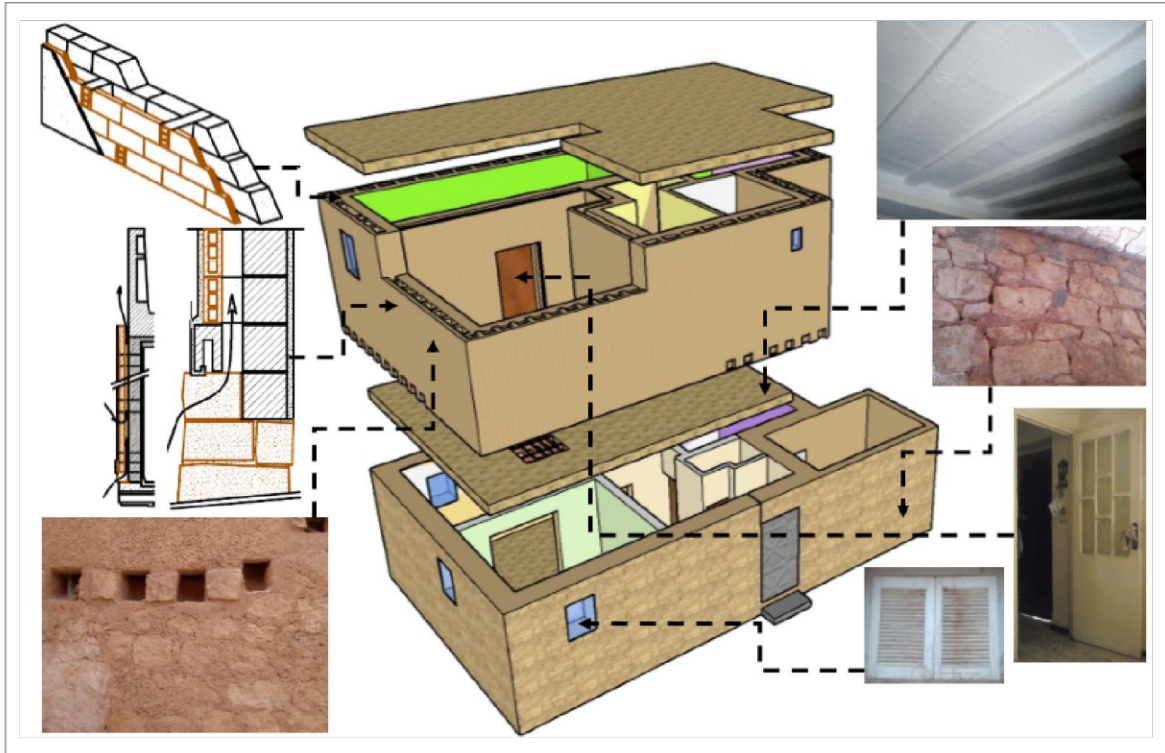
22 : Matériaux et systèmes constructifs constituant l'enveloppe du logement Sididi Abbaz.
